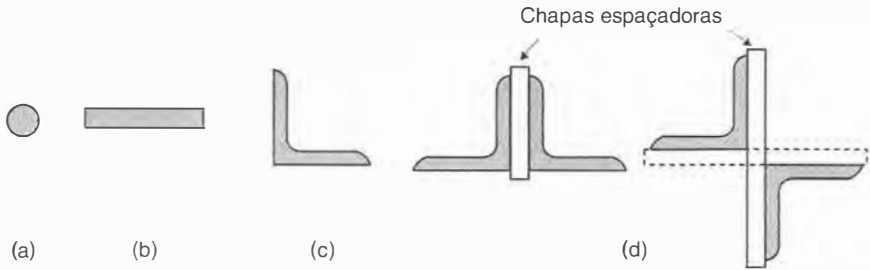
Tipos de perfis utilizados em peças tracionadas: (a) barra redonda; (b) barra chata; (c) perfil laminado simples (cantoneira); (d) seções compostas de dois perfis laminados (dupla cantoneira com faces opostas ou cantoneiras opostas pelo vértice).
